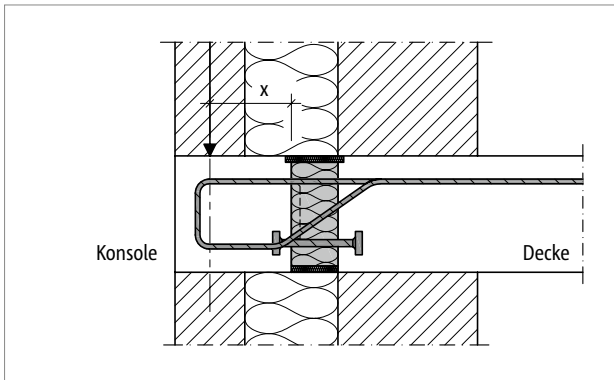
Schöck Isokorb® T Typ OP: Konsole mit Verblendmauerwerk
